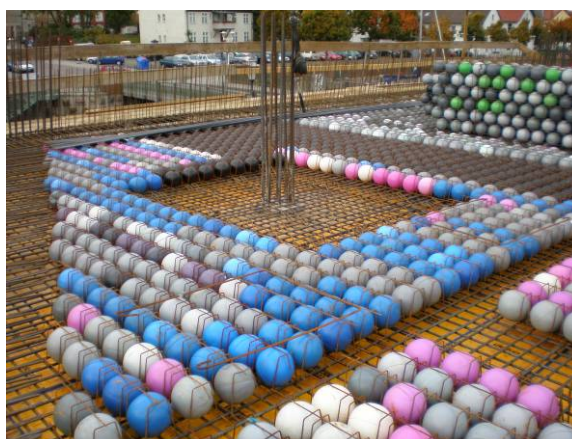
Verlegte Körbe mit Hohlkörpern auf der unteren Bewehrung
